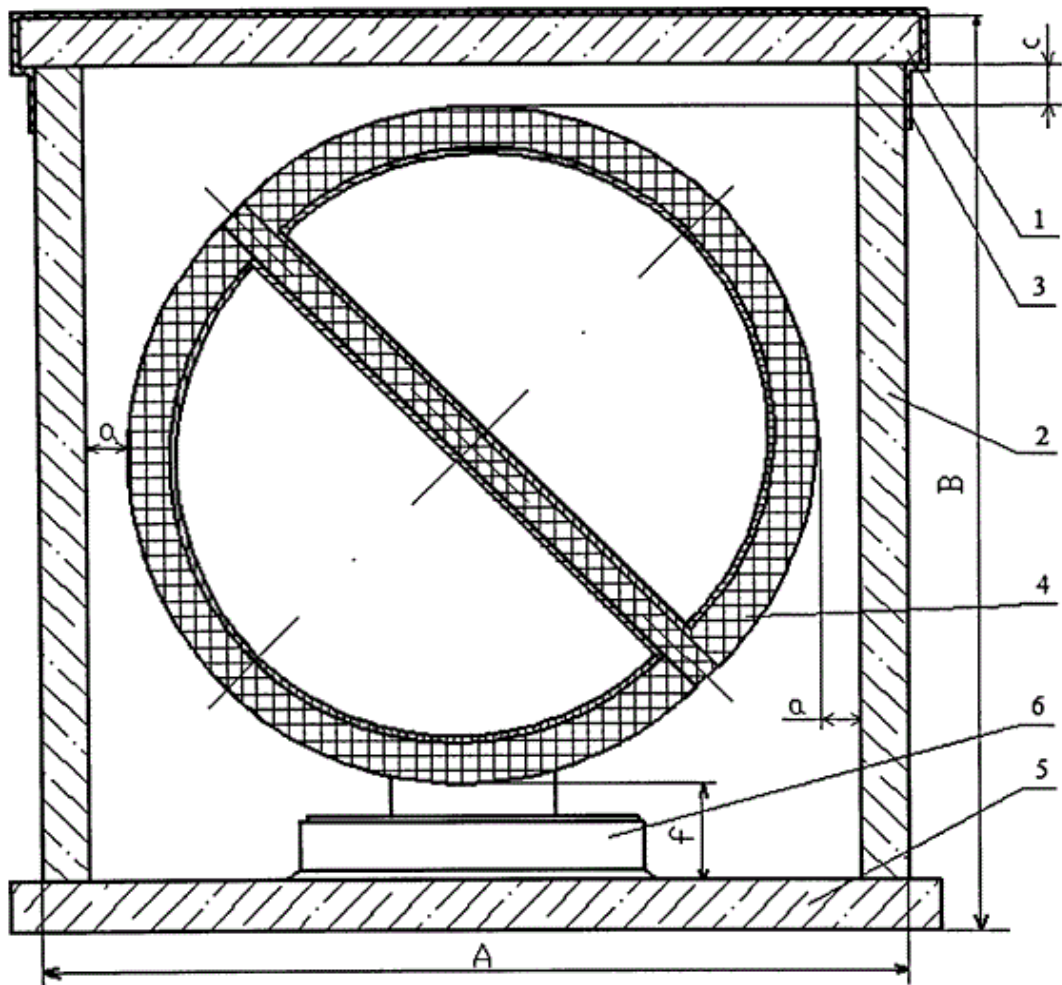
Поперечний переріз непрохідного каналу контактної конструкції із похилим розташуванням трубопроводу:
